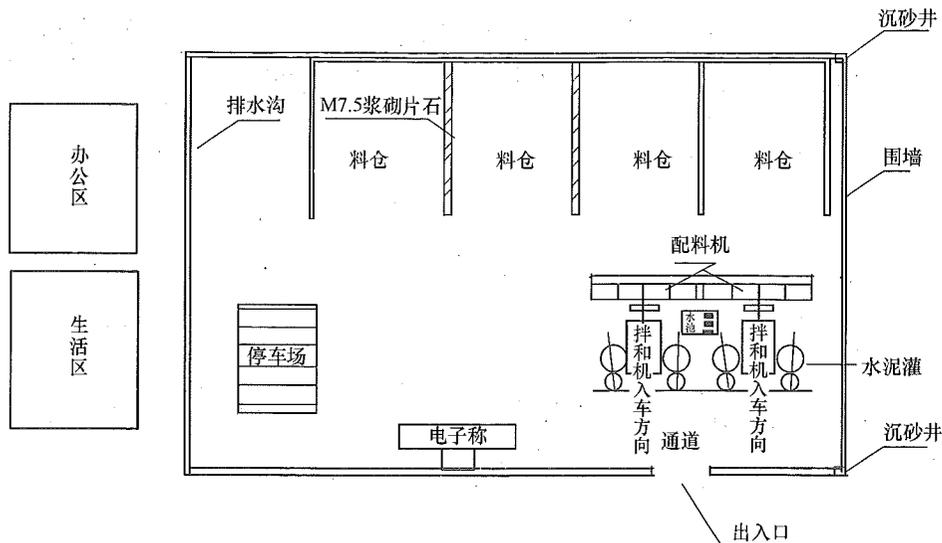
B320111-5 某水泥混凝土拌和站平面布置示意图
